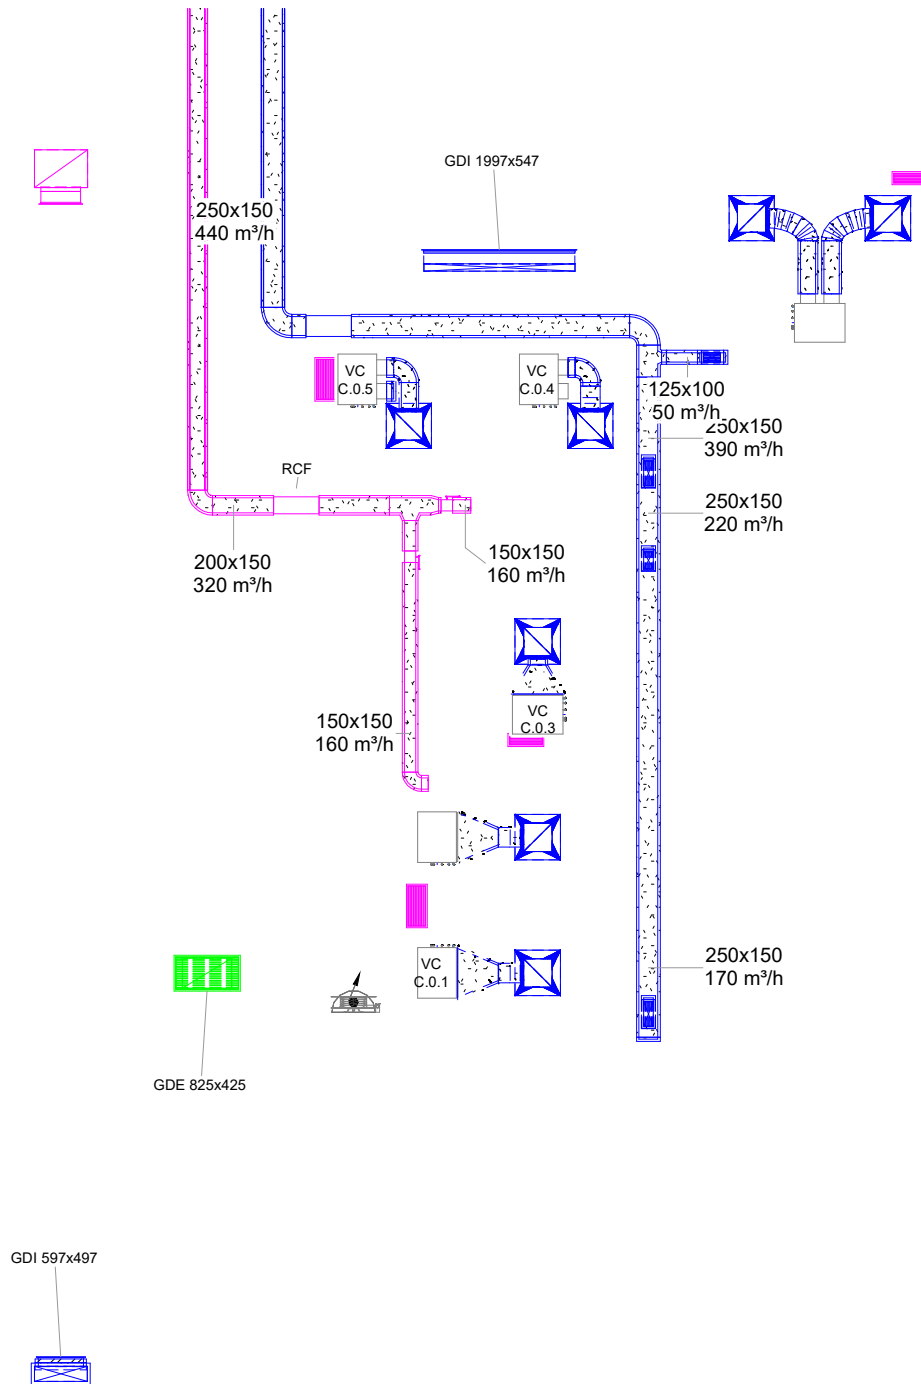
Seção 1.7 da planta geral do traçado das condutas no piso térreo à escala 1:100.
